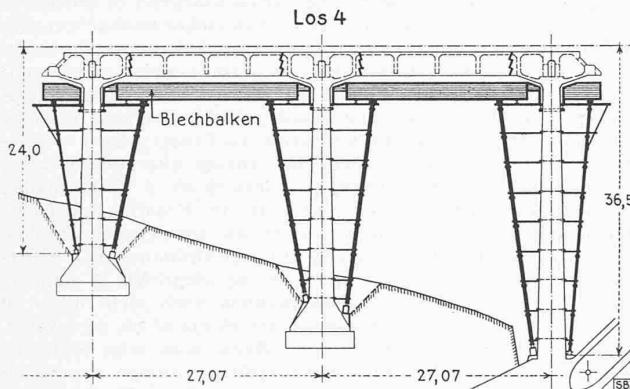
Gerüsttyp Los 4 mit geschweißten Stahlbalken
